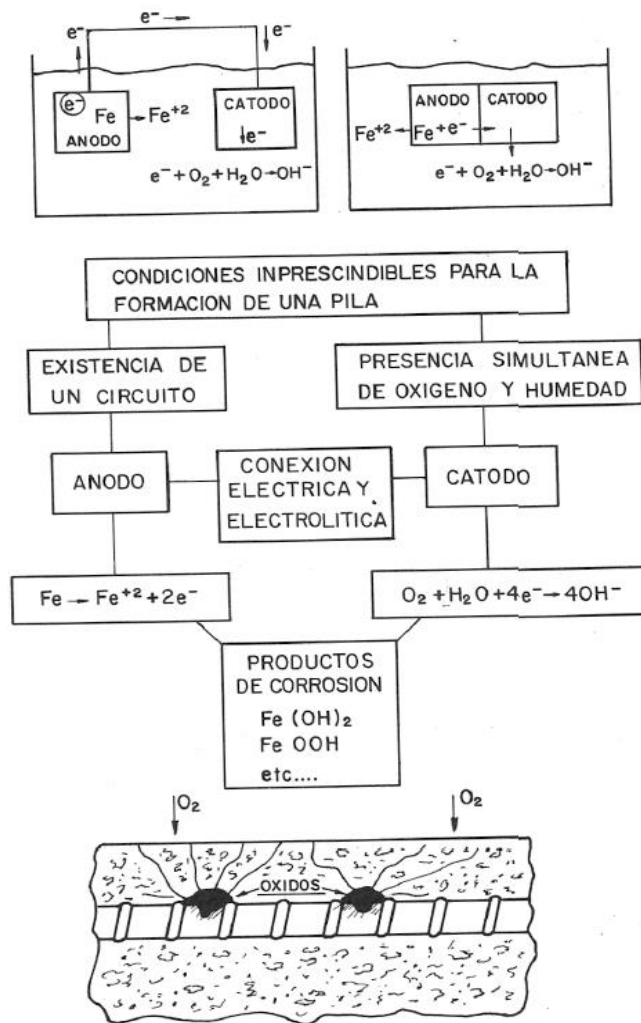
Proceso de deterioro de armaduras – pila de oxidación [5]
